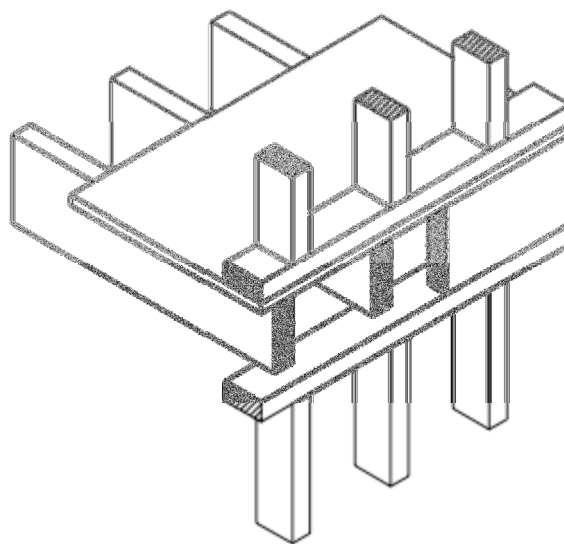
Detalle constructivo sistema “platform frame”
